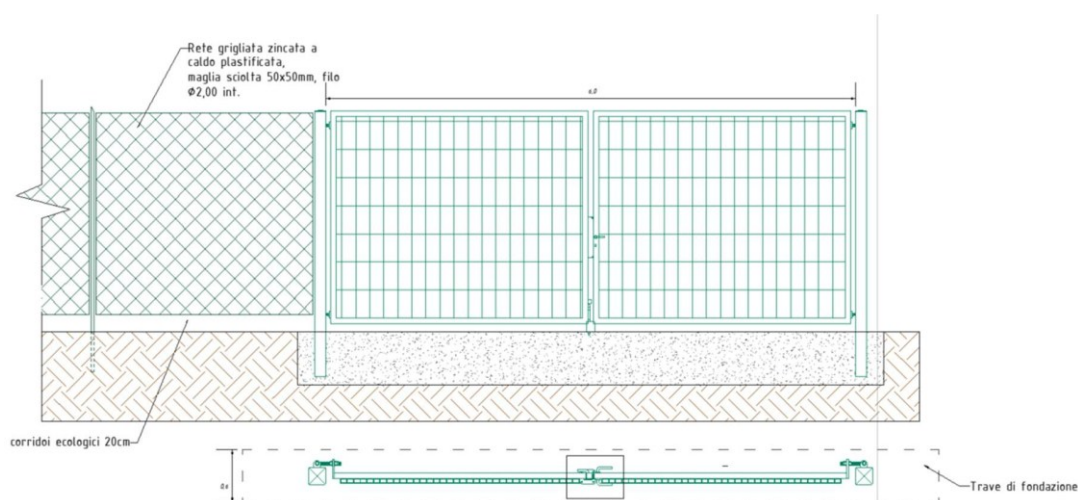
Rappresentazione della recinzione prevista di altezza pari a 2,5 m
